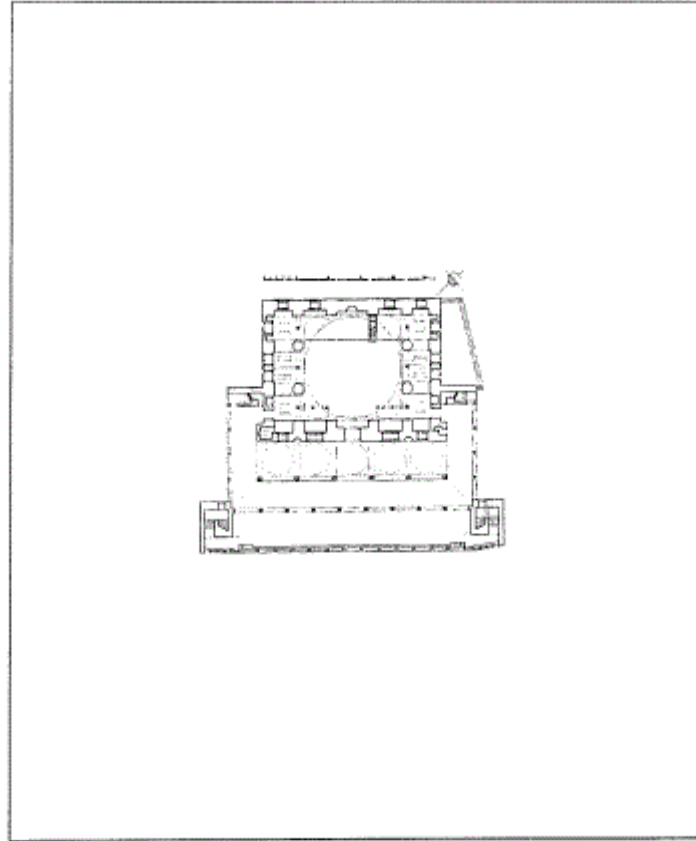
مسقط أفقي لمسجد جوزليج حسن بك في خيرابولو (عن : كوران) .
